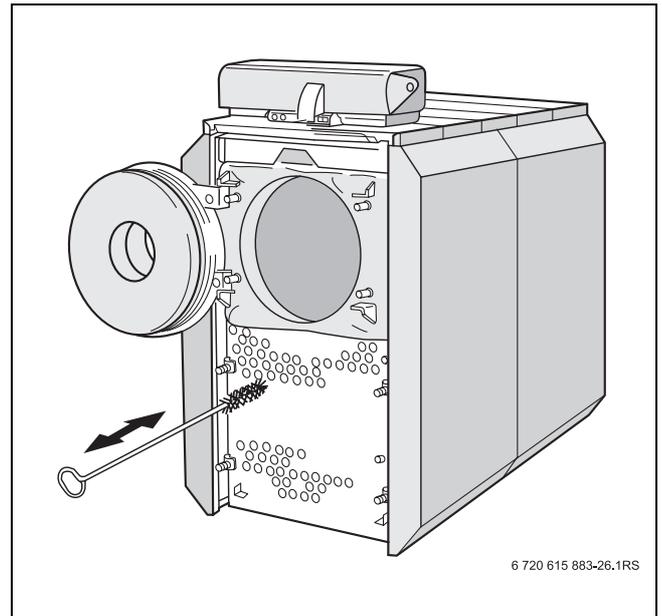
Чистка щёткой труб дополнительных поверхностей нагрева
